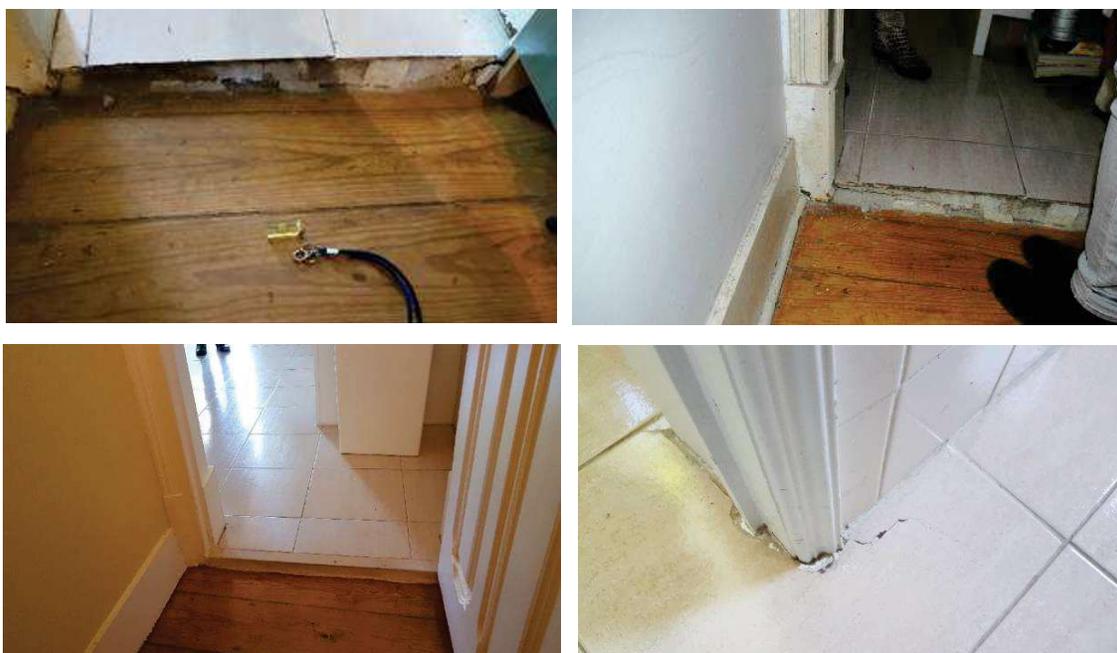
Pavimentos de cozinhas, evidenciando desligamento entre as camadas de madeira e betonilha e sinais de cedência da estrutura de suporte
